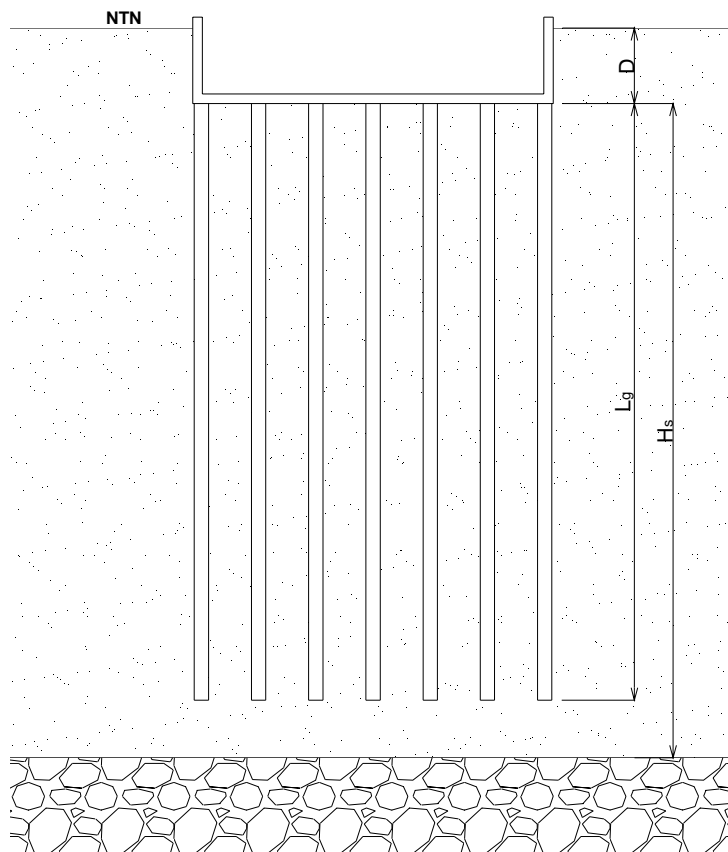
Distribución de pilotes debajo del cajón de cimentación
